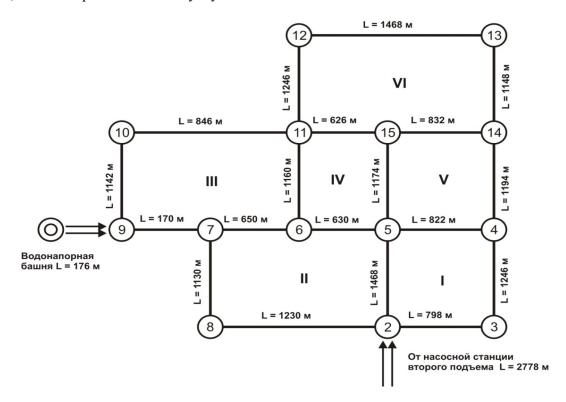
Расчетная схема водопроводной сети населенного пункта
